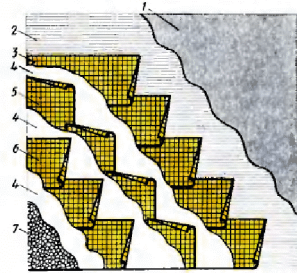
Раскладка полотнищ стеклохолста при устройстве мастичных кровель:
